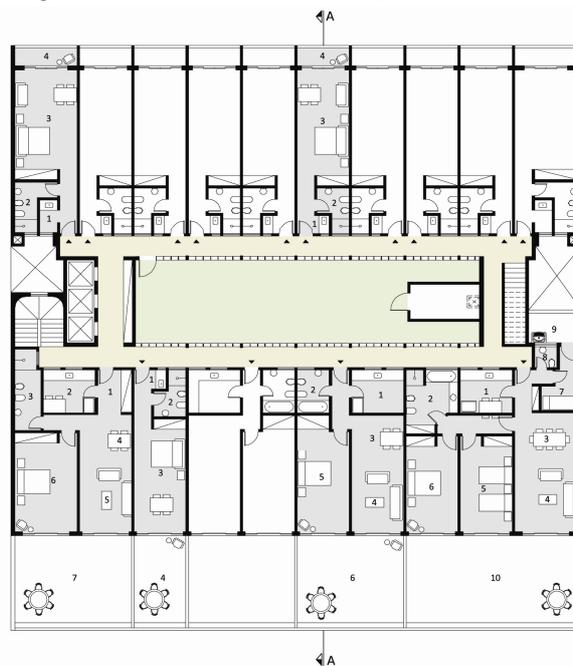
Planta do pav. tipo do Ed. Guaporé(desenho do autor)
